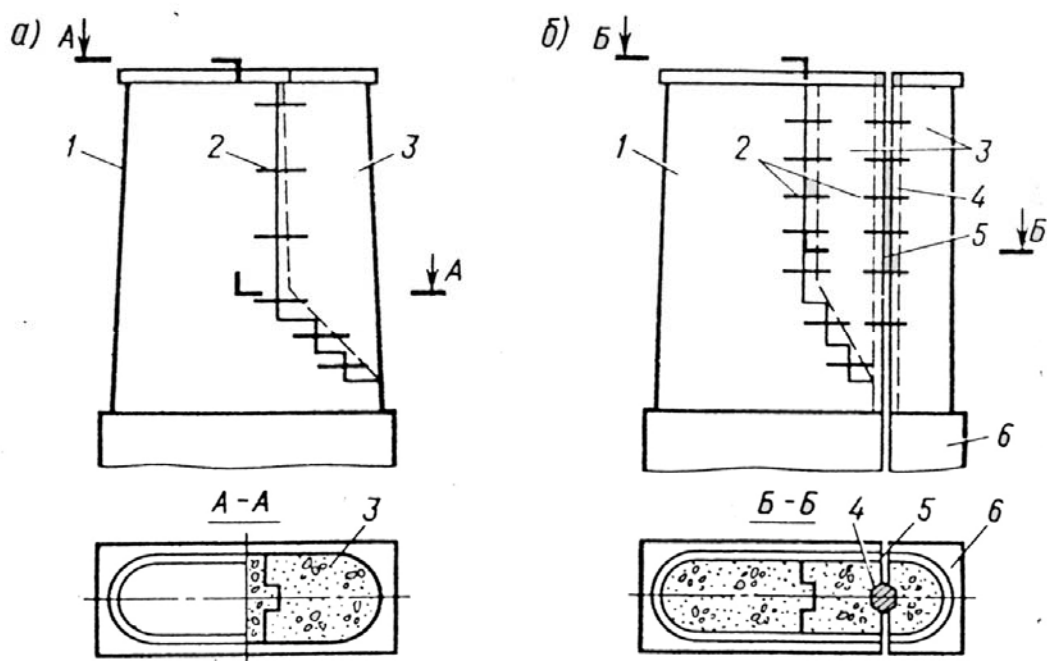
Уширение опор на общем (а) и на отдельных (б) фундаментах:
